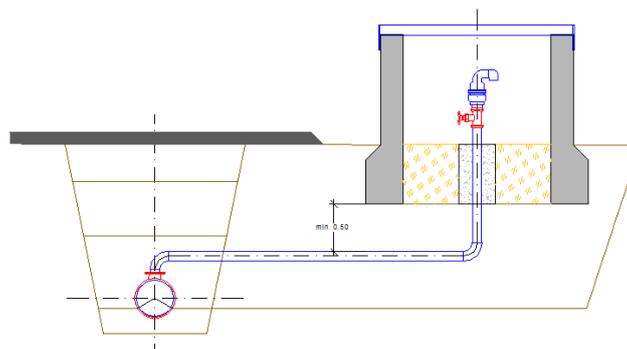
Detalle instalación ventosas en campos de cultivo desplazadas
